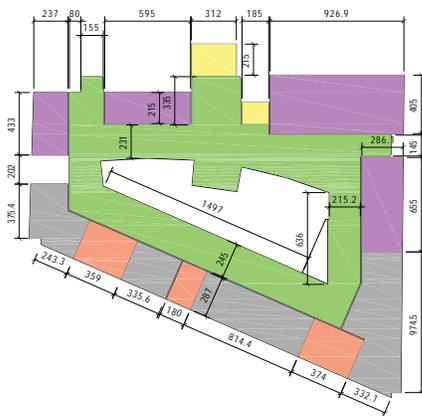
ESQUEMA ÁREA DE OCUPACIÓN PRIMER PISO.
